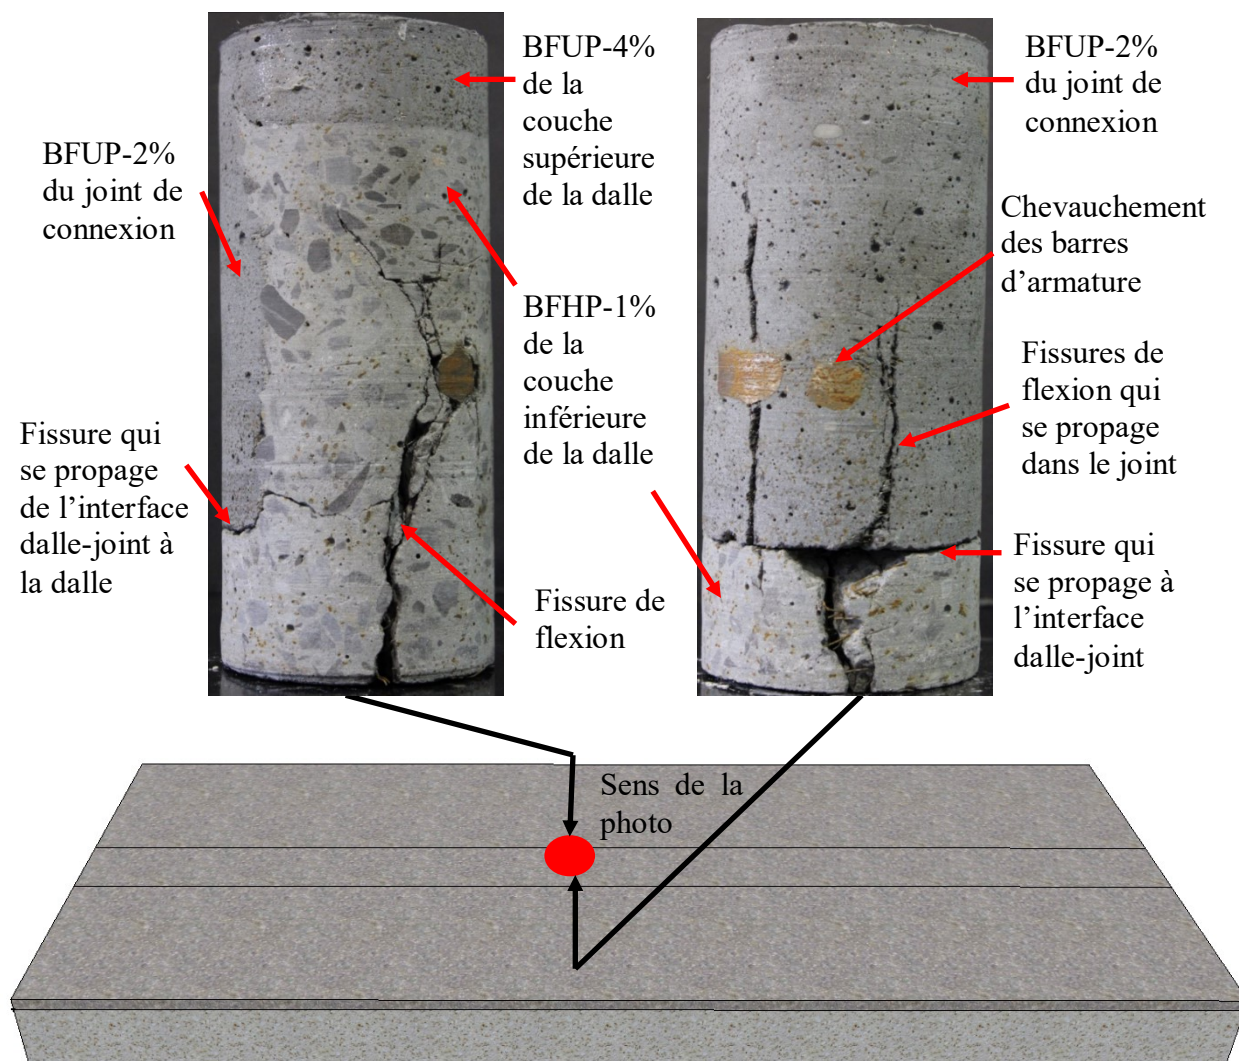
Carottage de la dalle hybride avec joint de connexion transversal soumise à un chargement en statique, carotte prise à l'interface dalle-joint du côté de la dalle chargée
